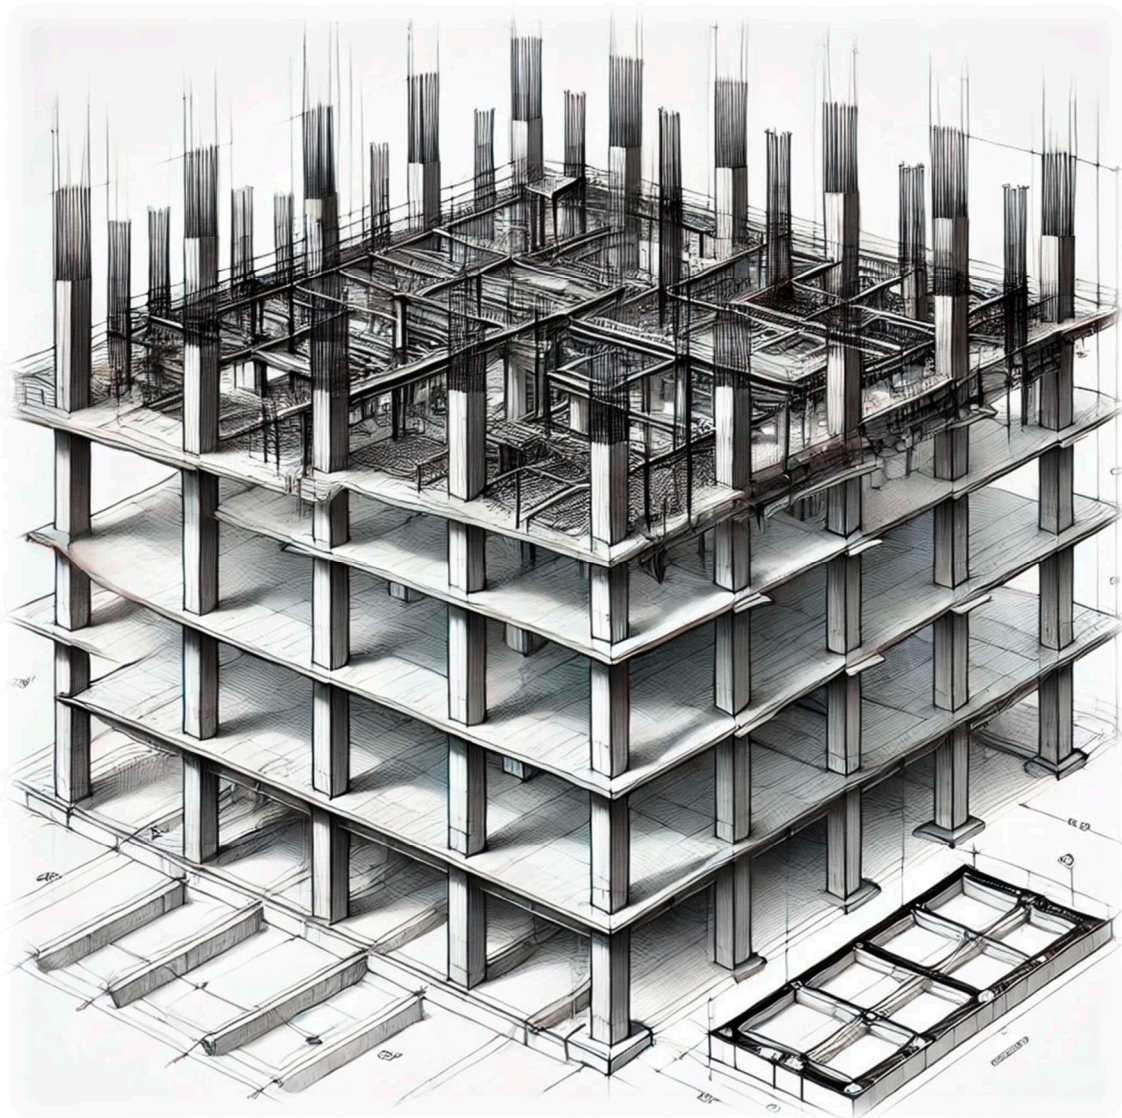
Exemplo de elementos estruturais (Vigas, Pilares, Lajes e Fundações)
